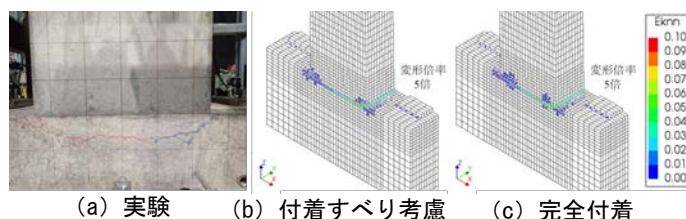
RG-R13の実験および解析のひび割れ状況 (δ=-3mm)
